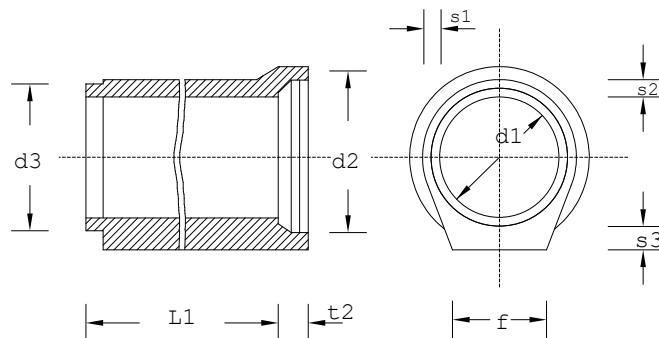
Tubi in calcestruzzo di sezione circolare con manicotto e con piede di appoggio
